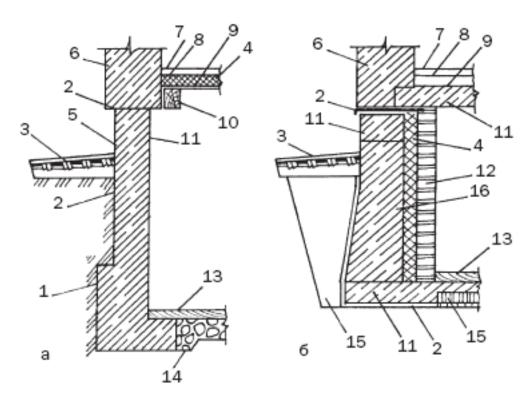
Конструктивные элементы подвала: а – в сухом грунте: б – в пучинистых перенасыщенных влагой грунтах; 1 – насыпной грунт; 2 – гидроизоляция; 3 – отмостка; 4 – утеплитель; 5 – асбоцементный лист; 6 – наружная стена; 7 – чистый пол; 8 – пароизоляция; 9 – черный пол; 10 – балка цоколя; 11 – железобетон; 12 – кирпичч; 13 – верхнее покрытие пола; 14 – щебень; 15 – слой жирной глины; 16 – бетон
